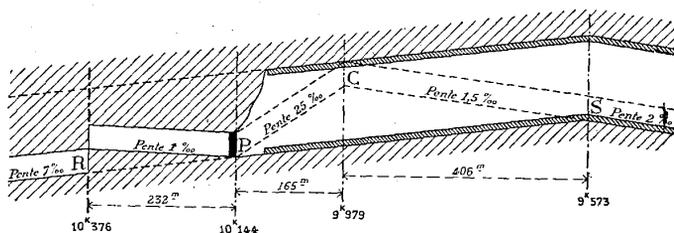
Coupe longitudinale du tunnel dans le voisinage du point de rencontre R des chantiers nord et sud
